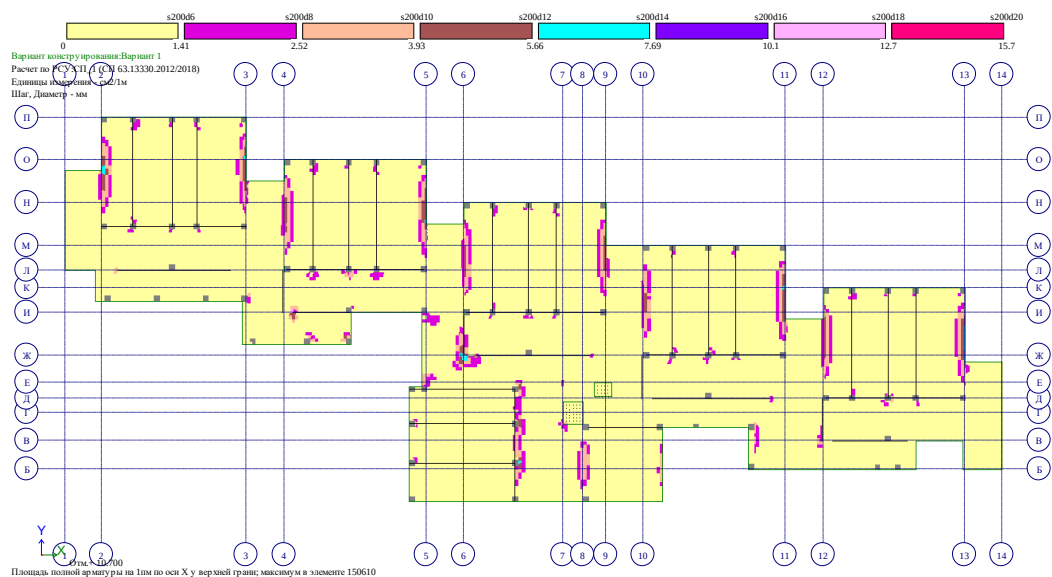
Схема армирования плиты перекрытия у верхней грани по оси X
